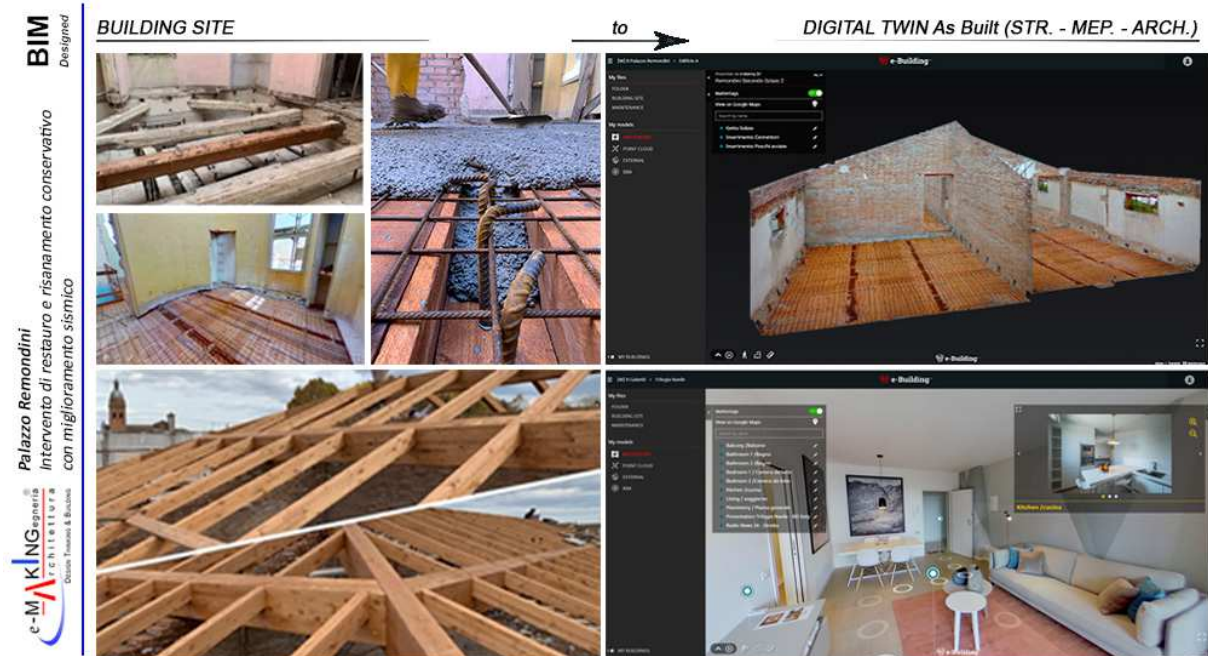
Flusso: dal cantiere ai Digital Twin as built (str. – mep. – arch.)
